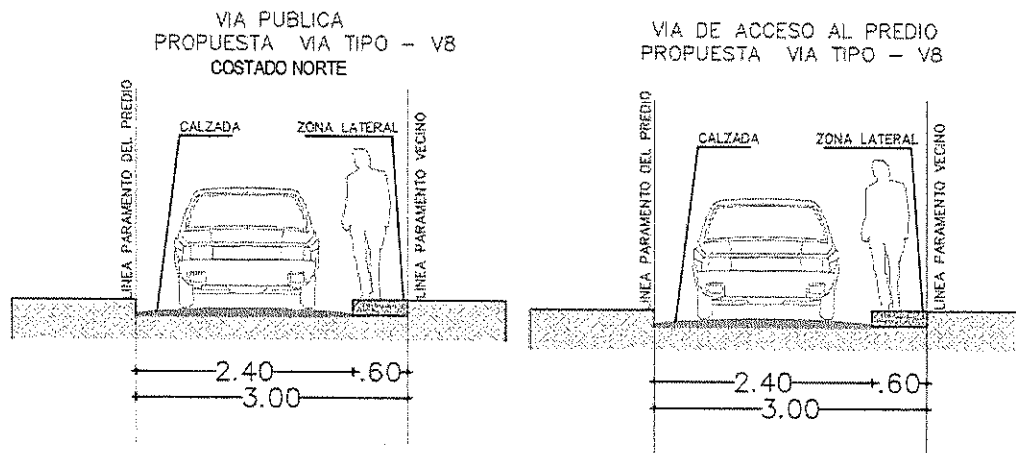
Perfil vial propuesto SERVIDUMBRE PUBLICA y LOTE VIA DE ACCESO
